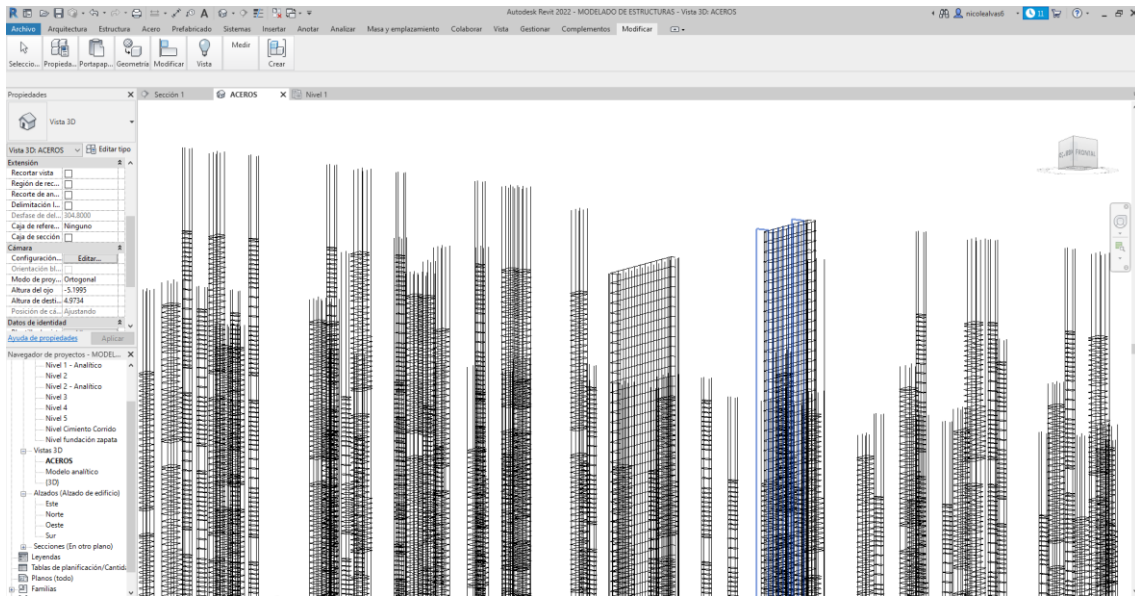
Visualización en 3D del refuerzo estructural de columnas y placas
